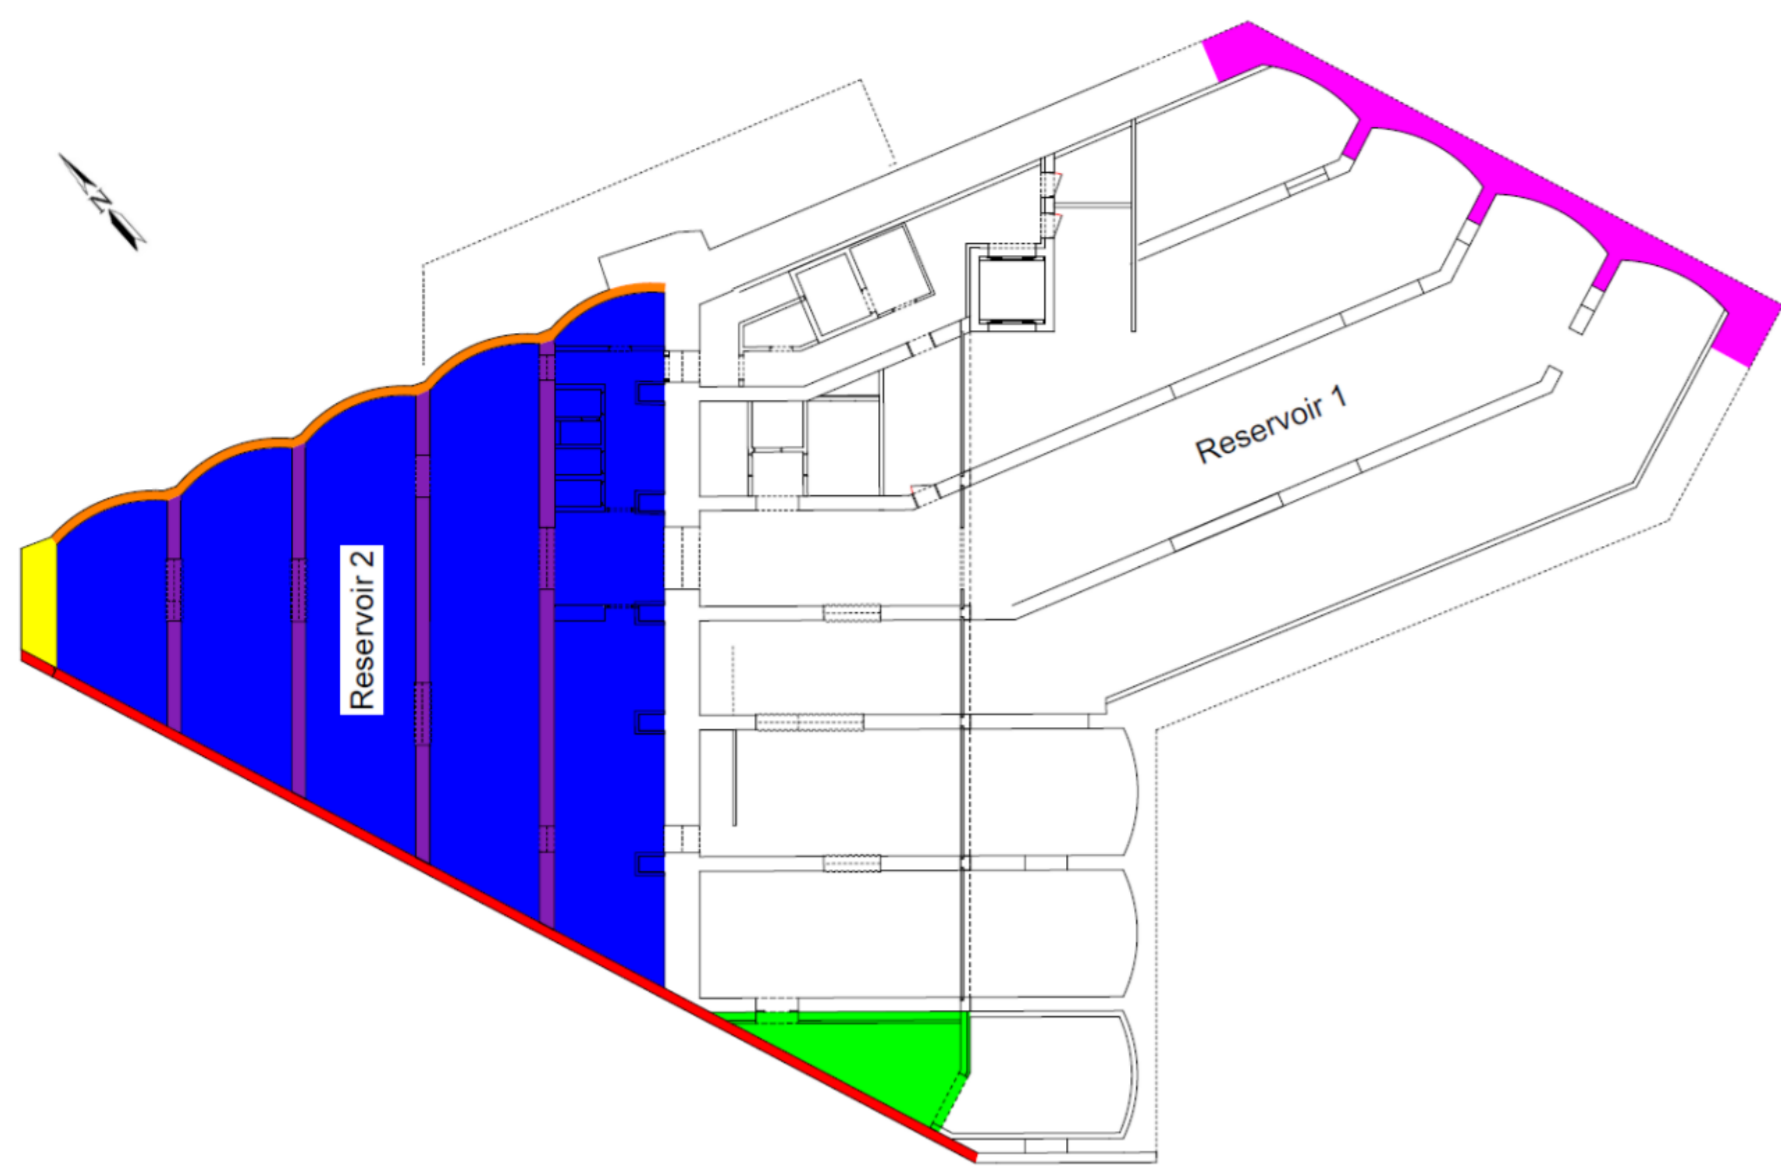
Grundriss des Trinkwasserreservoir mit den Abgrenzungen
